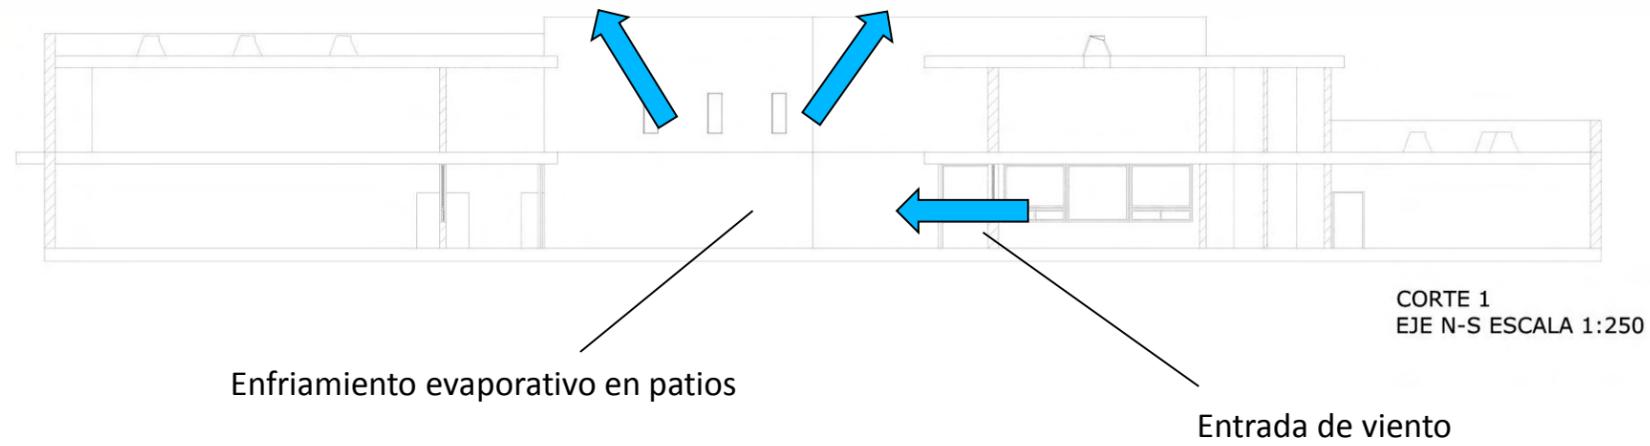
Proyecto fachadas estrategias bioclimáticas
